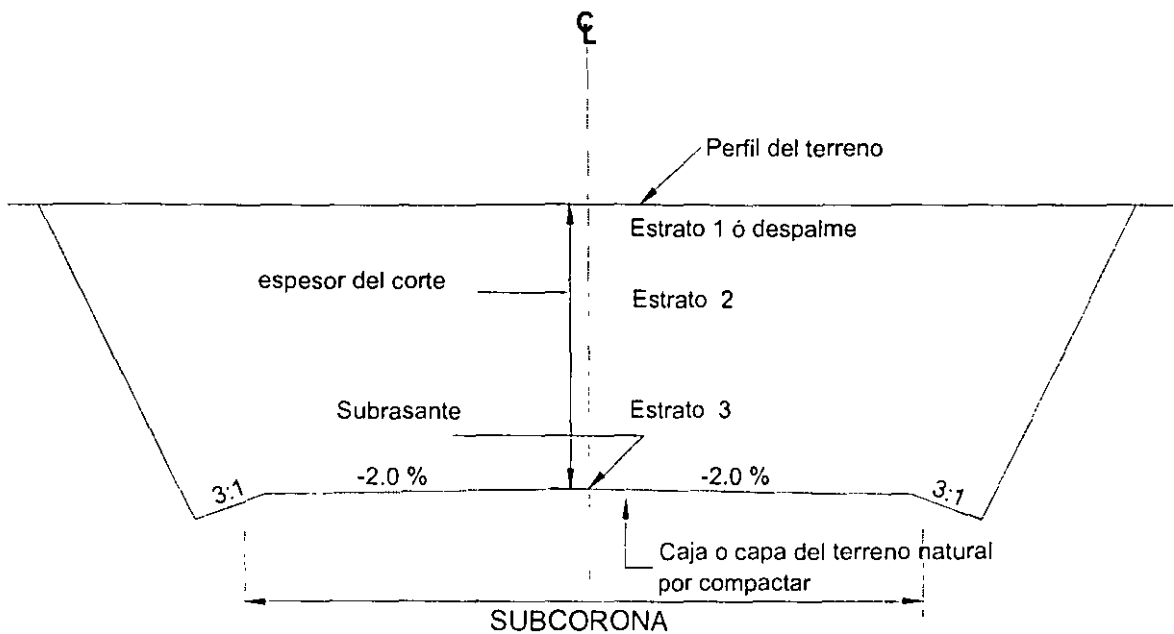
SECCION DE CONSTRUCCION DE UN CORTE EN TANGENTE
